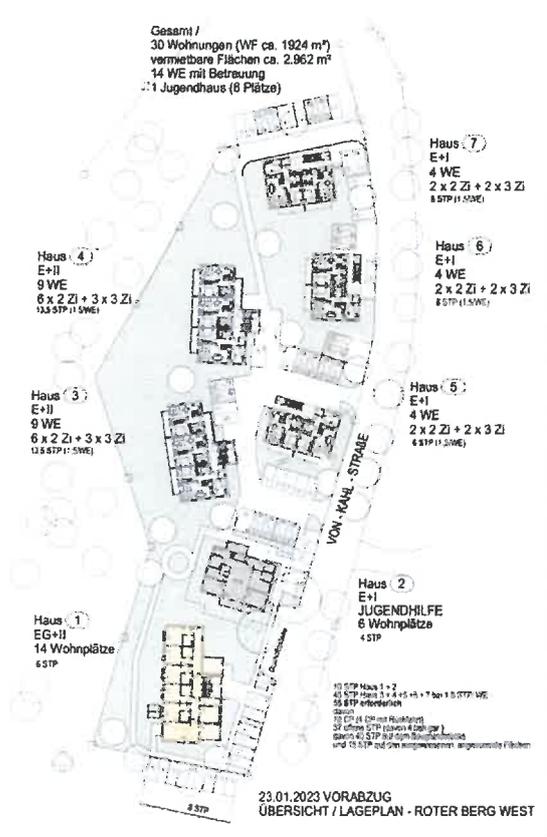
Übersichtsplan Architektur plan3architekten mbB; Planungsstand 01/2023
